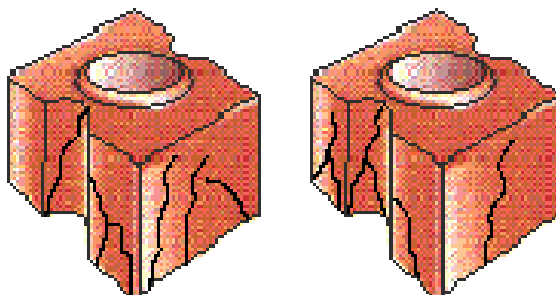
Bloco TJ 111 com a fissuração típica nas faces norte, oeste, sul e leste
